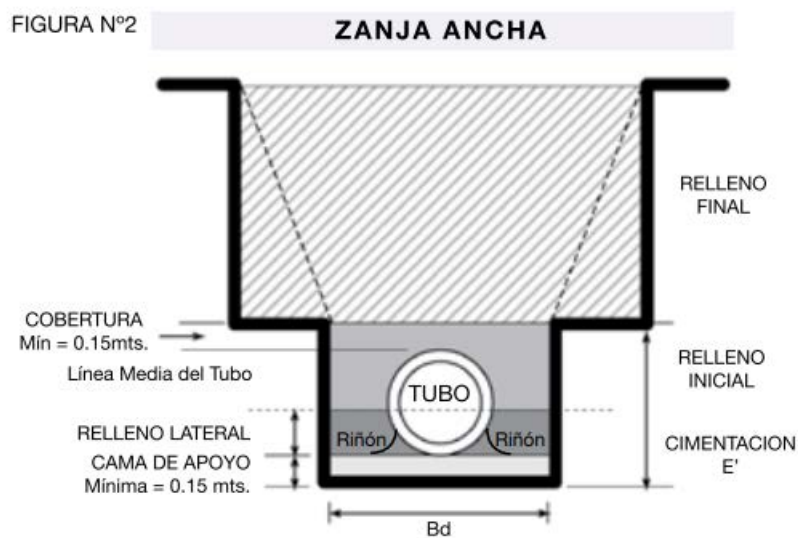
Detalle de ancho de zanja (Pavco Wavin, 2020)
